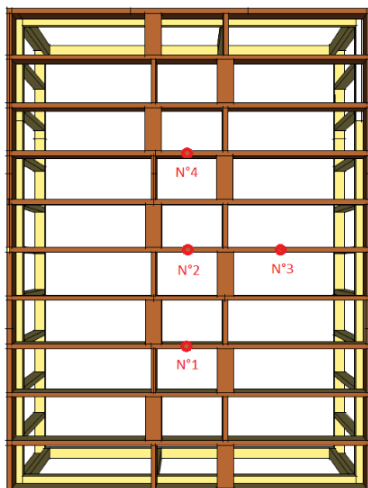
Vista en planta de la ubicación de los acelerómetros en la estructura (elaboración Propia).
